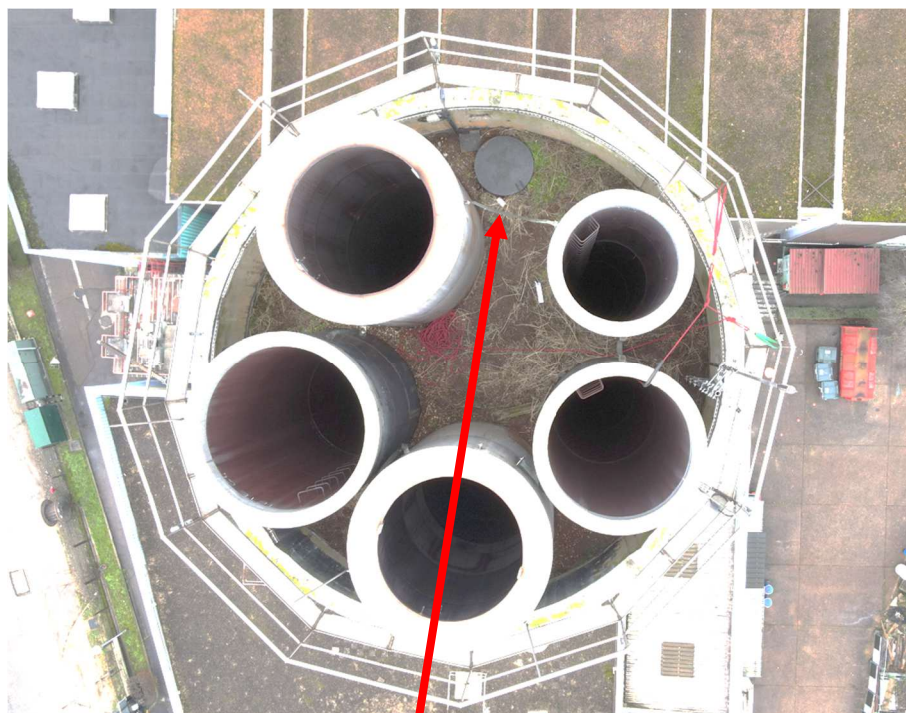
Dalle supérieure recouverte de graviers, terre et végétation.
